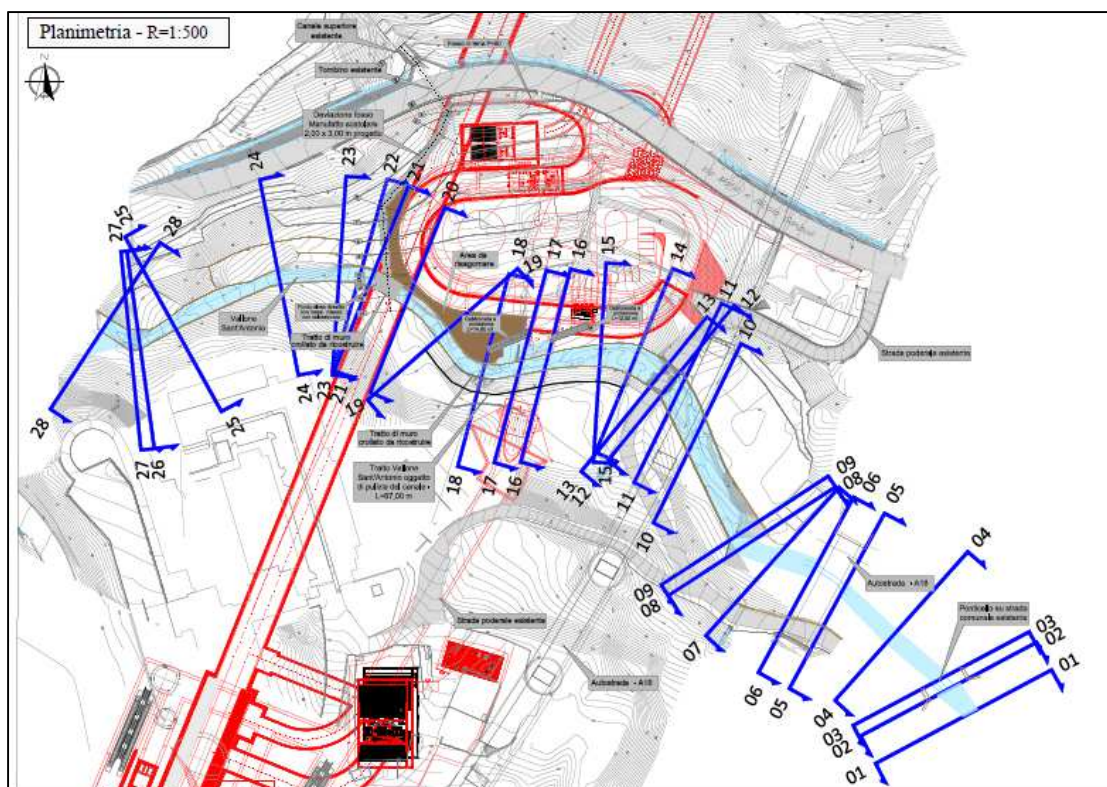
Stralcio planimetrico del ponticello sul Vallone San’Antonio alla Pk 13+700
